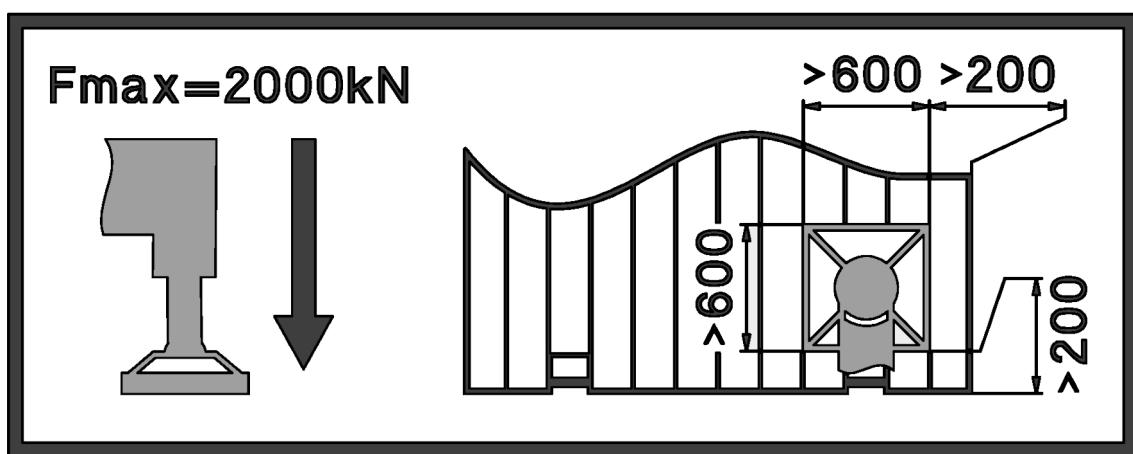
La placa de apoyo se coloca fuera del centro en la plancha de apoyo
